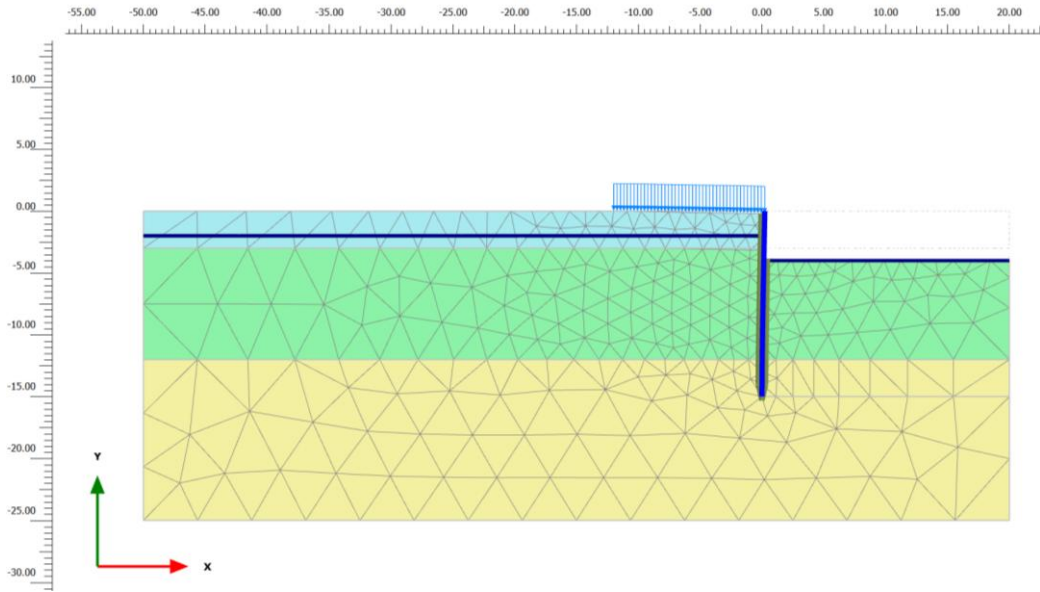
Общий вид расчетной схемы для 1-го варианта рассматриваемого котлована – консольное шпунтовое ограждение котлована глубиной 4 м.
